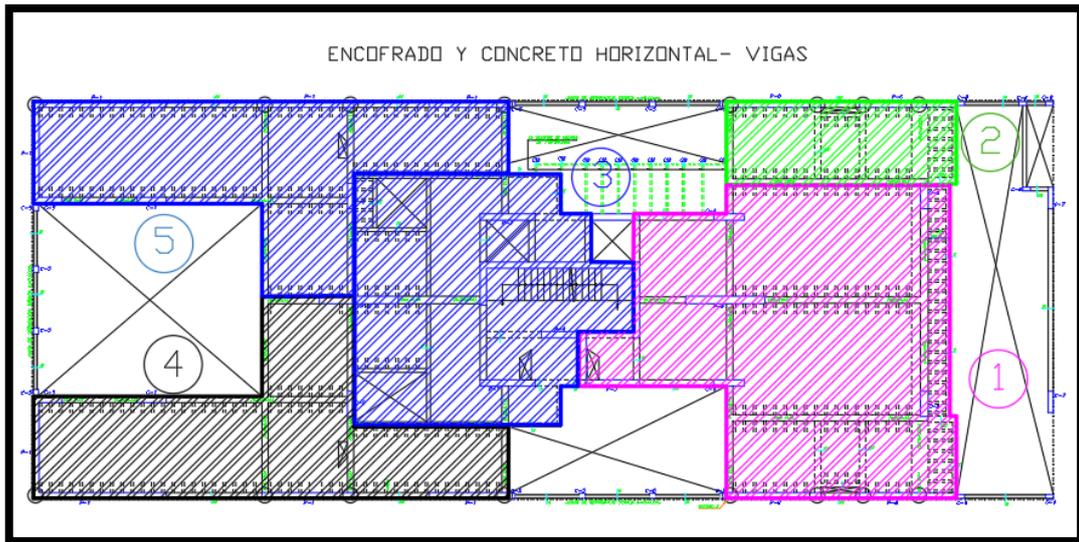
Sectorización de Elementos horizontales para encofrado y Concreto – Piso 1.
